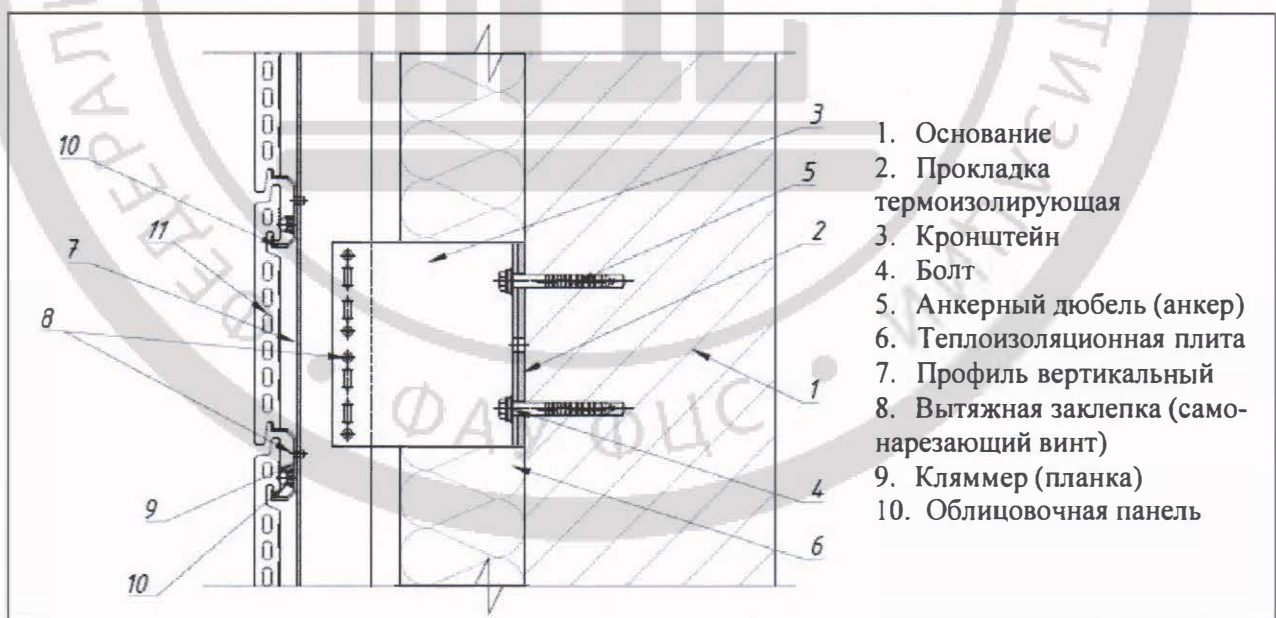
Вертикальный разрез фасадной системы «МТС-в-350» (первый вариант конструктивного исполнения несущего каркаса)
